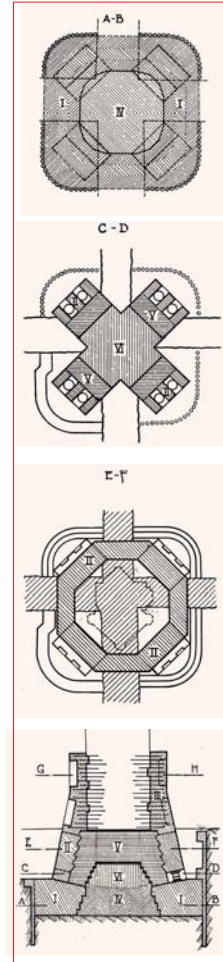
Erneuerungsarbeiten des Turmpfeilerfundaments. Schematische Darstellung in Schnitt und Grundrissen der sechs Bauvorgänge.
